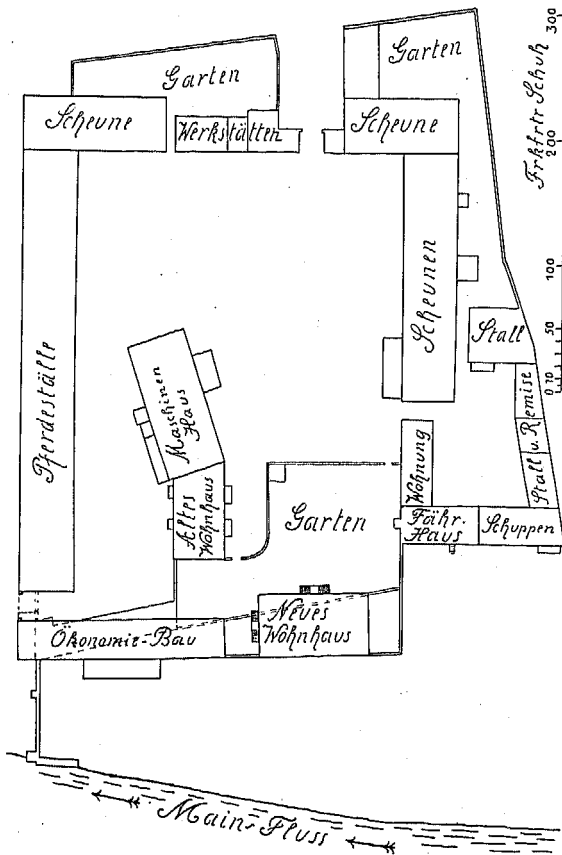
Gutleut-Hof; Plan aus dem Jahre 1867.
